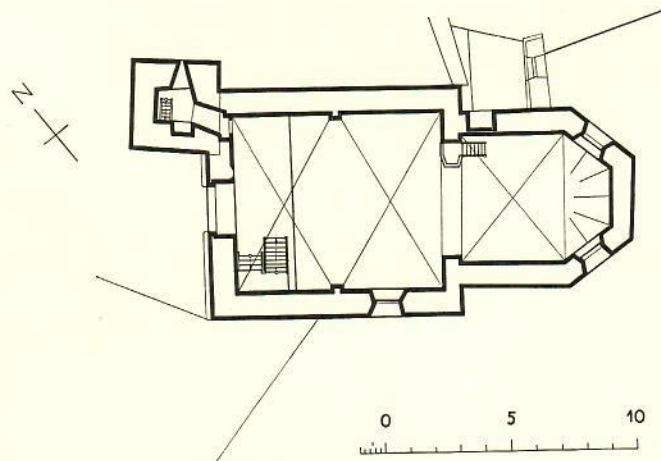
Grundriss. — Maßstab 1:300.
